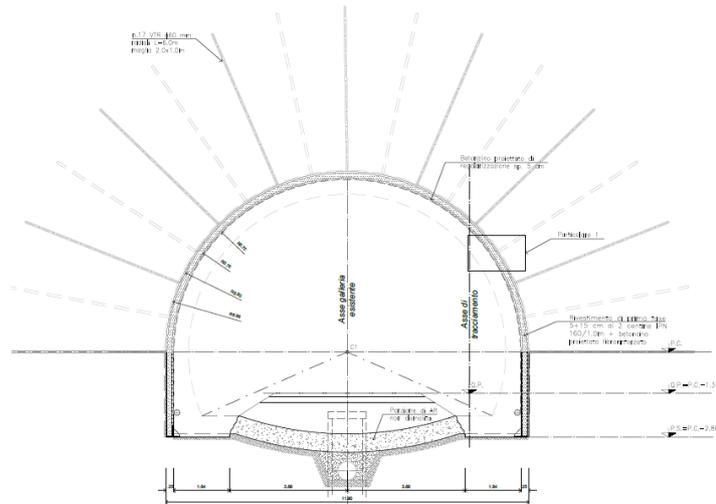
Galleria Guinza – Intervento Tipo A – Sezione corrente – Scavo – Sez. 2
